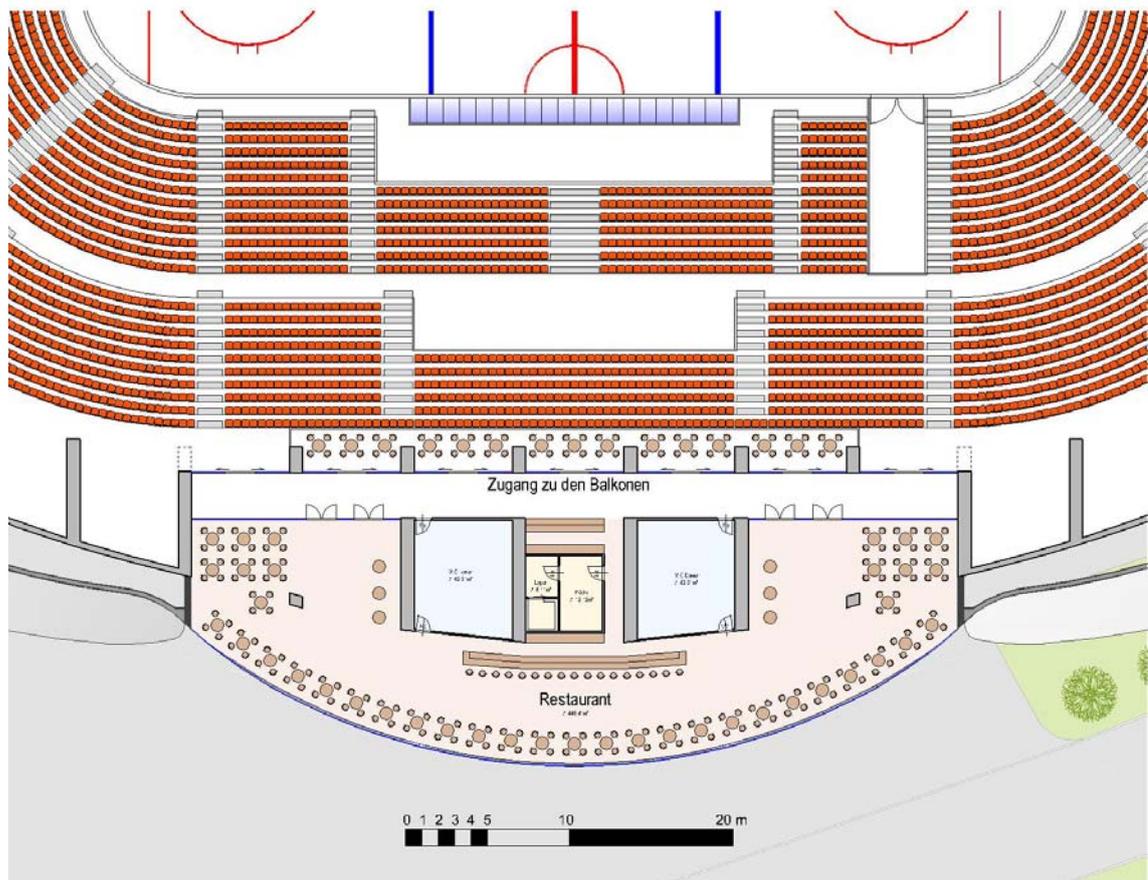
Grundriss des Hallenrestaurants im Obergeschoss. Das Restaurant selbst hat eine Fläche von rund 445 m² und bietet mit der umlaufenden Glasfassade einen Ausblick über einen großen Teil des Vorplatzes und in Richtung des Minimundus-Geländes. Zum Restaurantbereich gehören auch ein Küchenbereich und zwei Sanitärbereiche. Unmittelbar hinter den Tribünen sind kleine Boxen angeordnet, von denen aus man direkten Blick über die Eisfläche und den Haupteingang im Untergeschoss (der freie Tribünenbereich darunter) hat.
